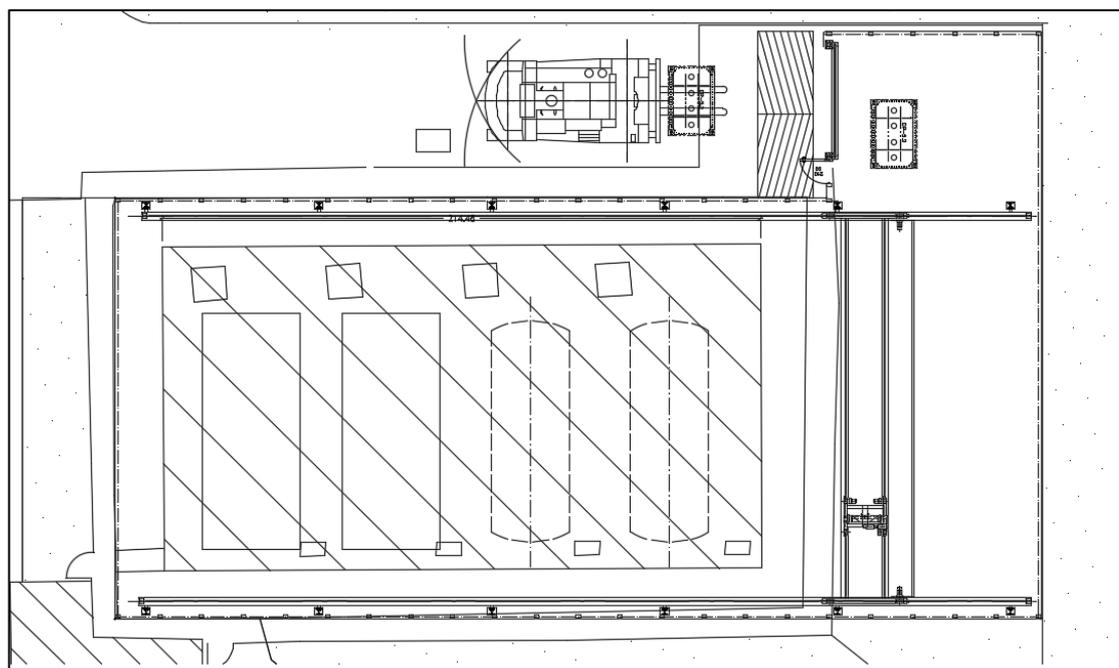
Facility di smantellamento edificio 21f – Pianta
